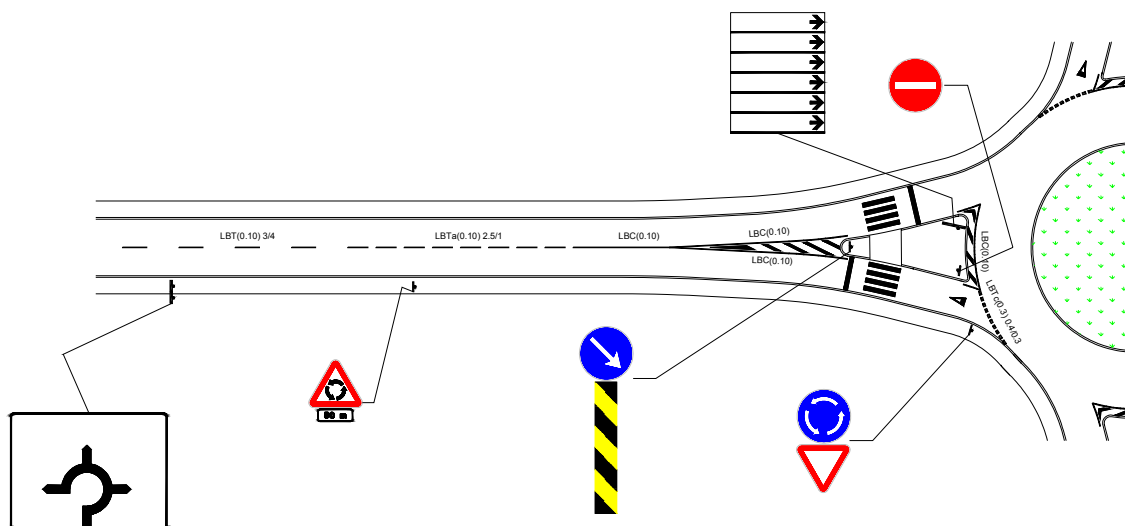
Sinalização vertical de rotundas – exemplo em arruamento
